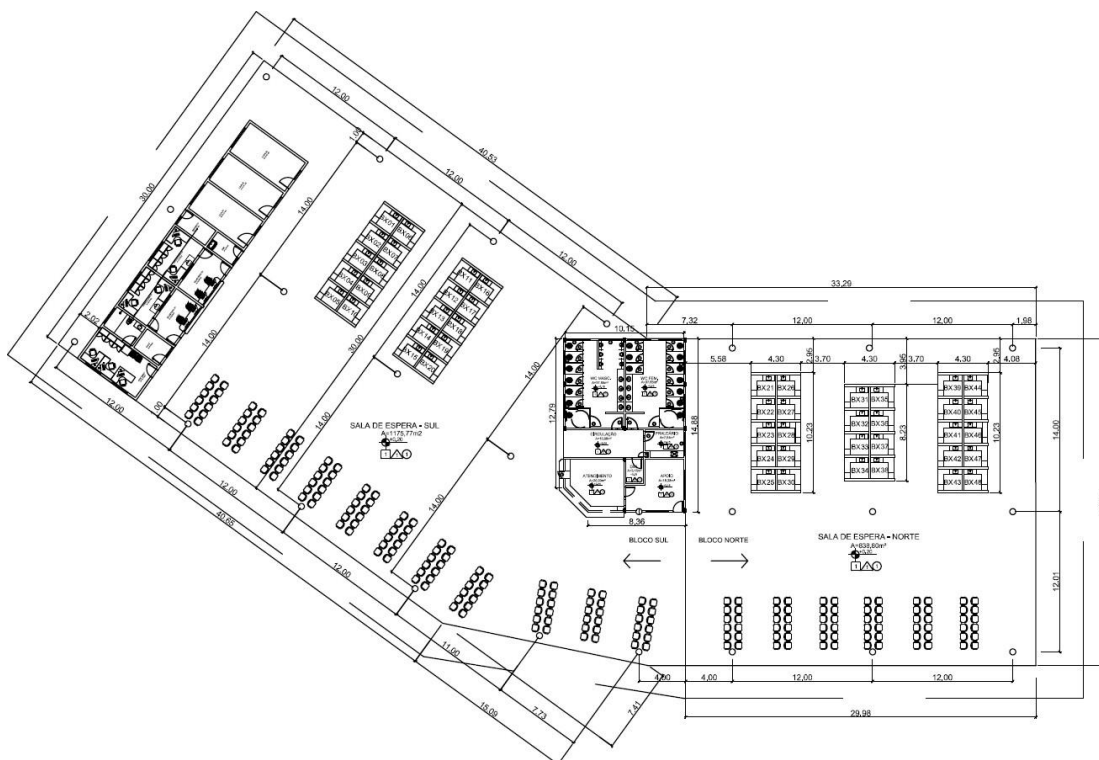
Planta baixa do Terminal de Passageiros do Cujupe
